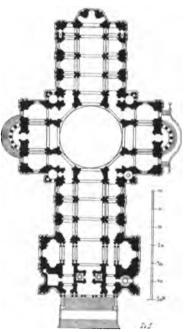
Pauls-Kathedrale zu London. Grundriss.
